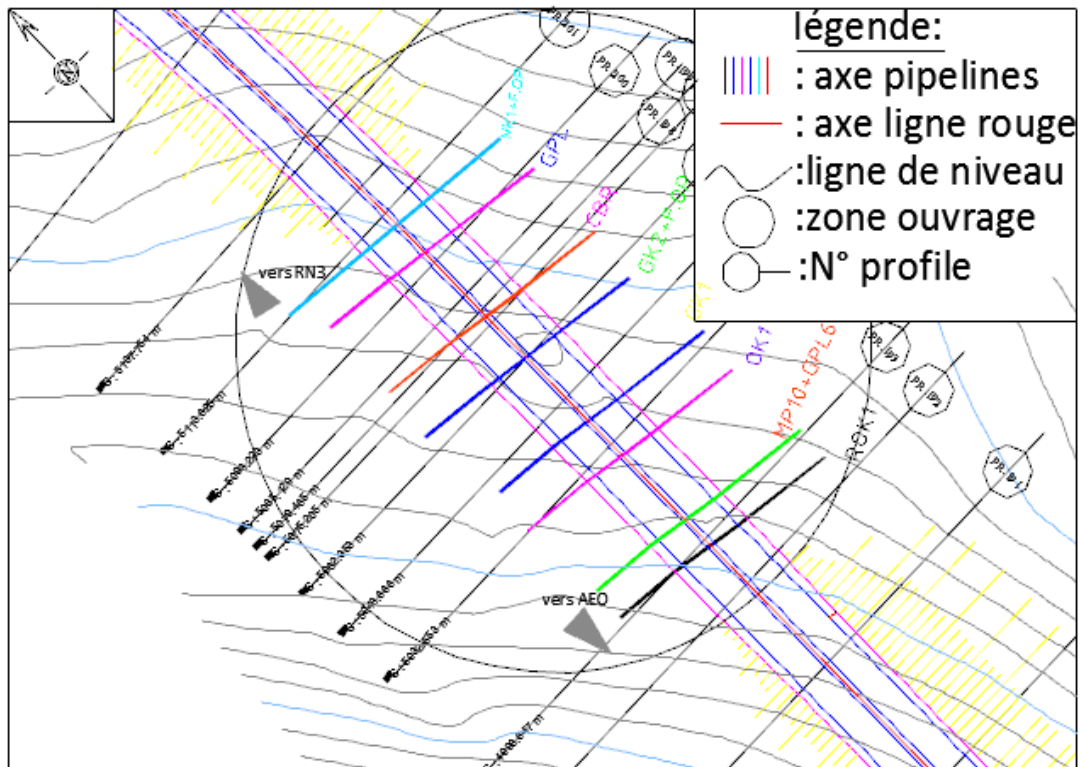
vue en plan de la zone d'emplacement de l'ouvrage
